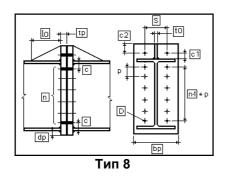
Монтажные стыки балок с использованием фланцевых соединений
